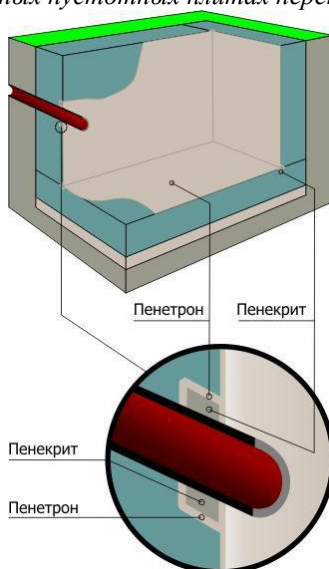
Гидроизоляция мест ввода коммуникаций материалом Пенекрит
